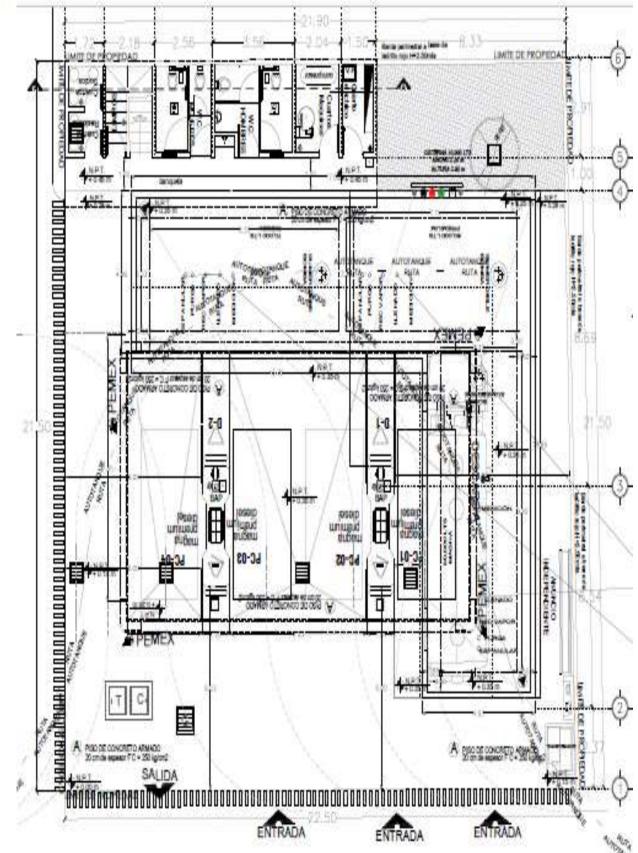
Plano de Conjunto de la GLAFIRA VARGAS SALMERON
